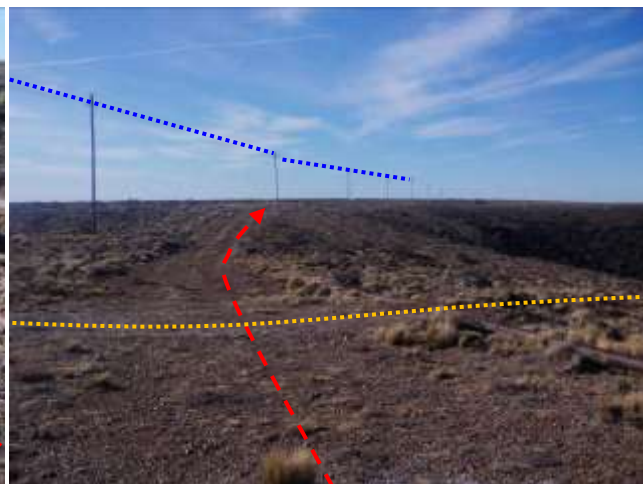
Futuro emplazamiento por picada, interferencia con línea eléctrica (azul) y picada (naranja). Foto en dirección Este.
